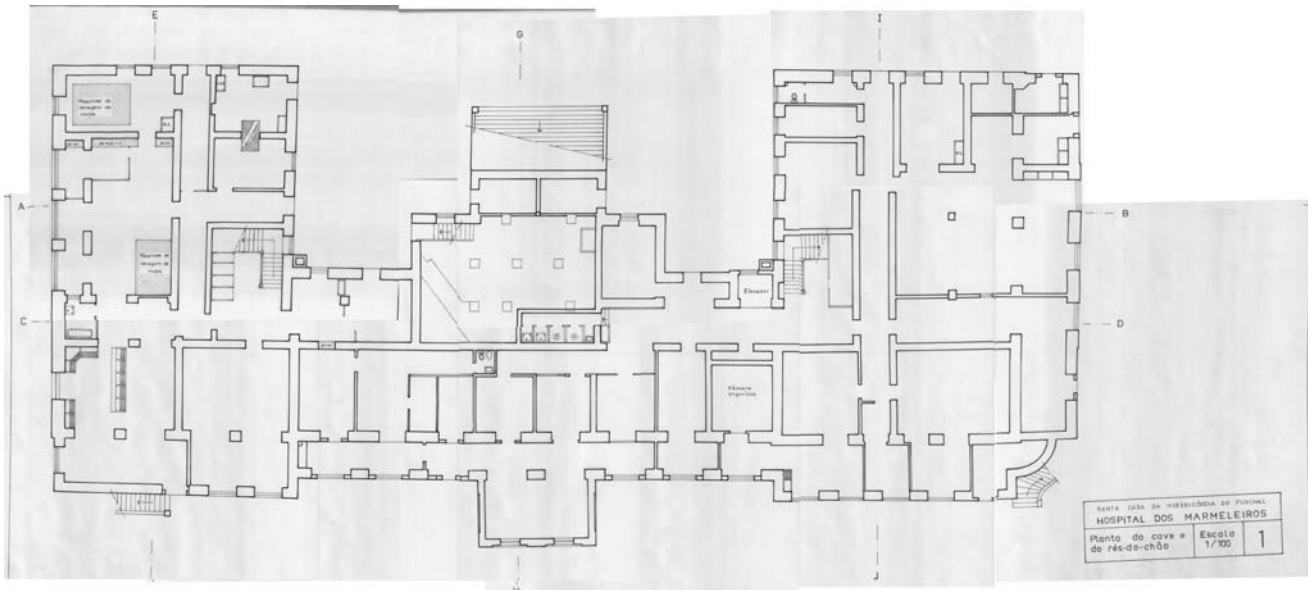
Sanatório dos Marmeleiros, Planta da Cave e RC. Planta 1. DGCH, s/r.
